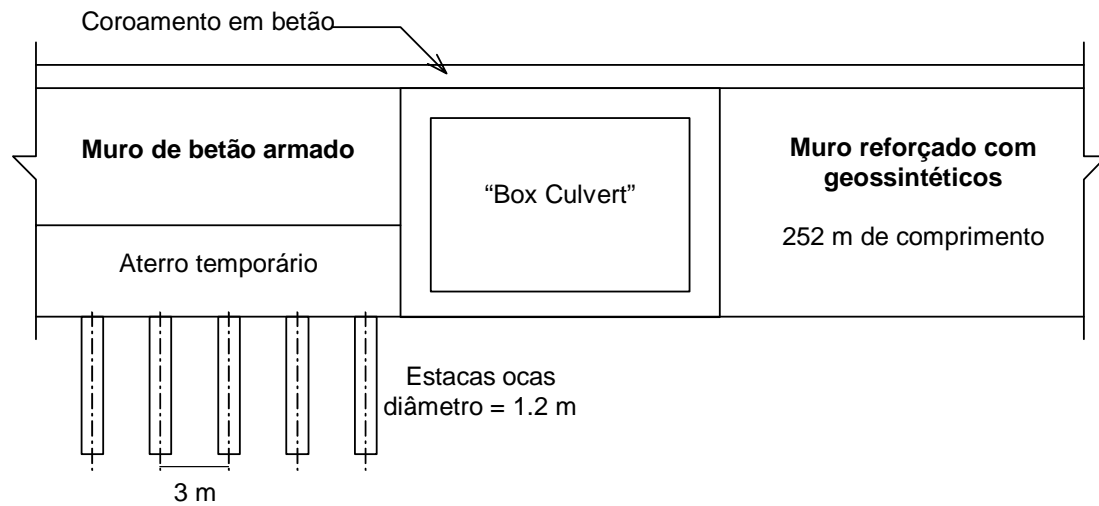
Esquema da localização dos muros reforçado com geossintéticos e de betão armado na zona de Tanata, Japão (adaptado de [4]).
